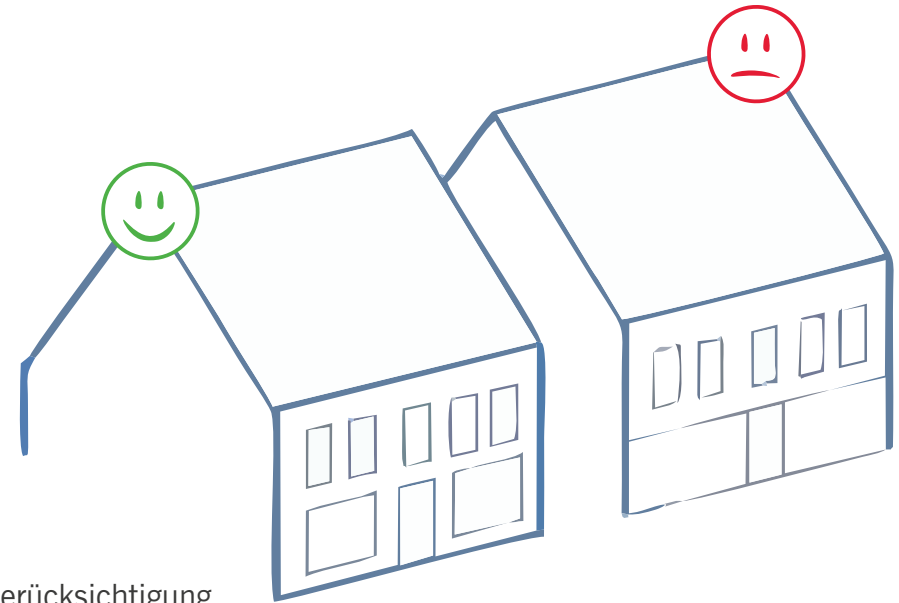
gelungene Gestaltung der Erdgeschosszone unter Berücksichtigung der Obergeschosse links im Vergleich zur isolierten Erdgeschossgestaltung rechts
